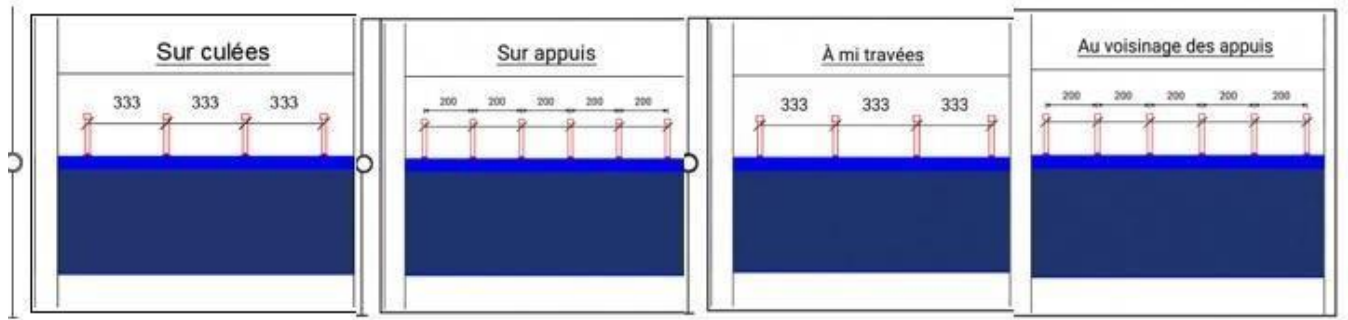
Disposition longitudinale des goudons dans les différentes sections
